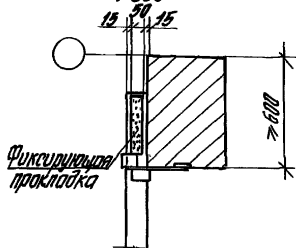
В поперечных перегородках у крайних колонн здания с высотой сечения колонны ≤ 500
